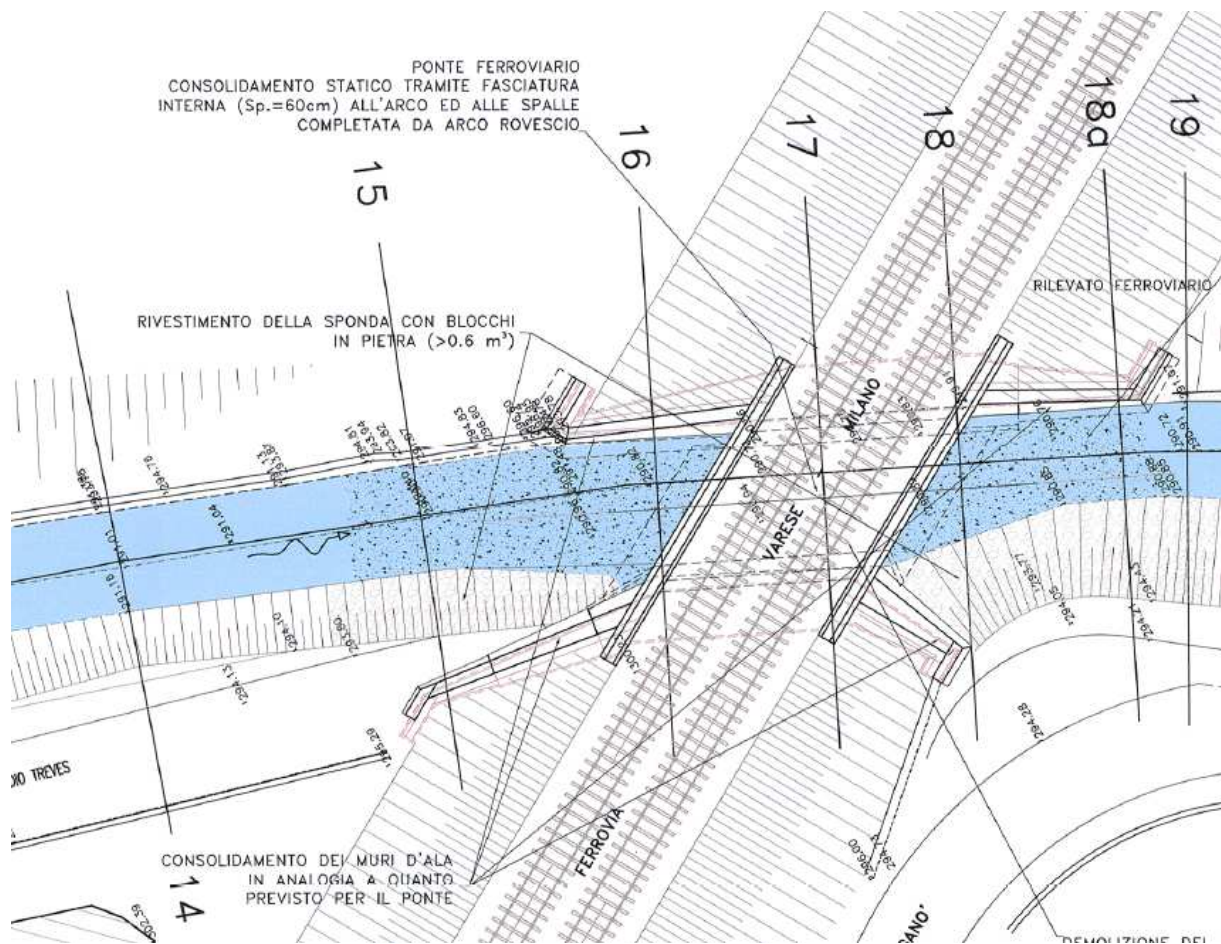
Stralcio planimetria con indicazione delle sezioni, stato attuale
